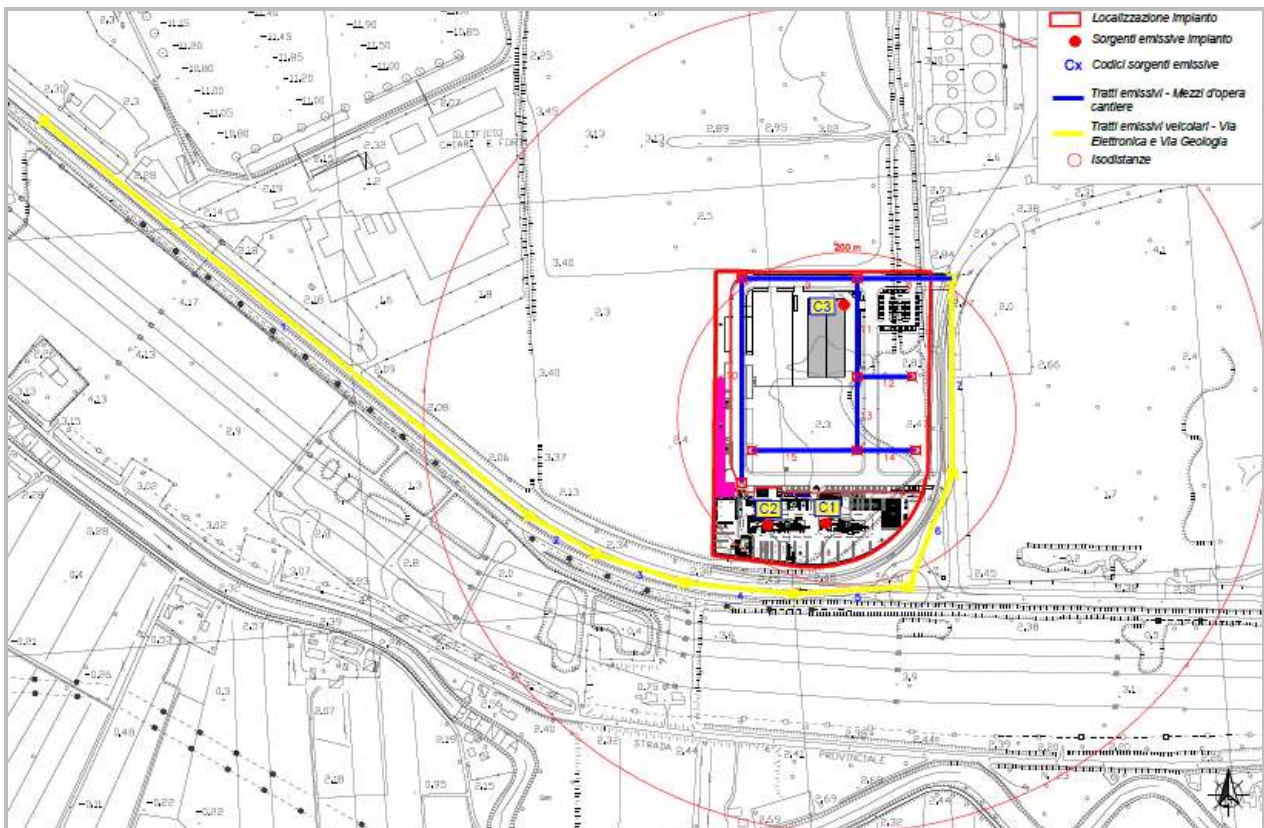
Planimetrie stato attuale con individuazione sorgenti emmissive
